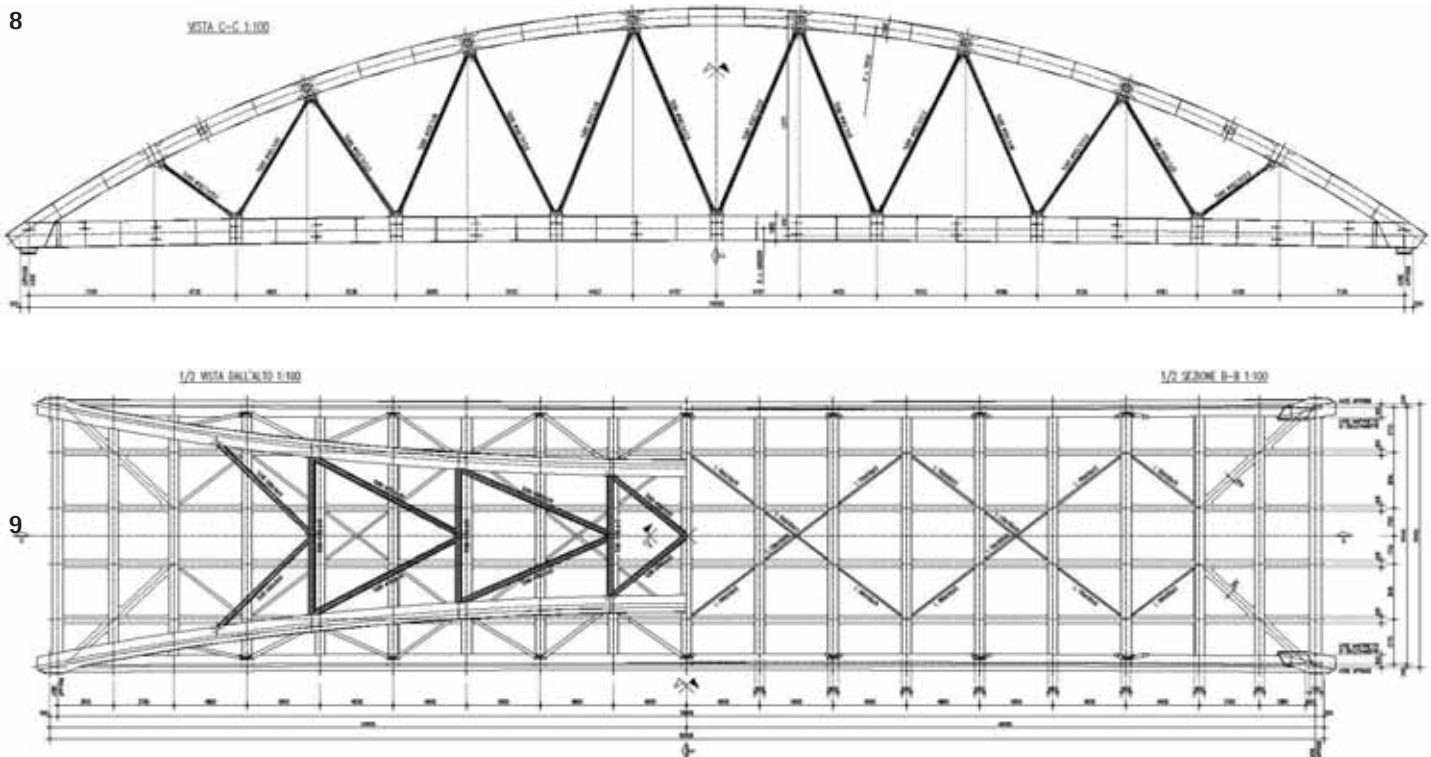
Sezione longitudinale. Fig. 9 - Pianta impalcato
